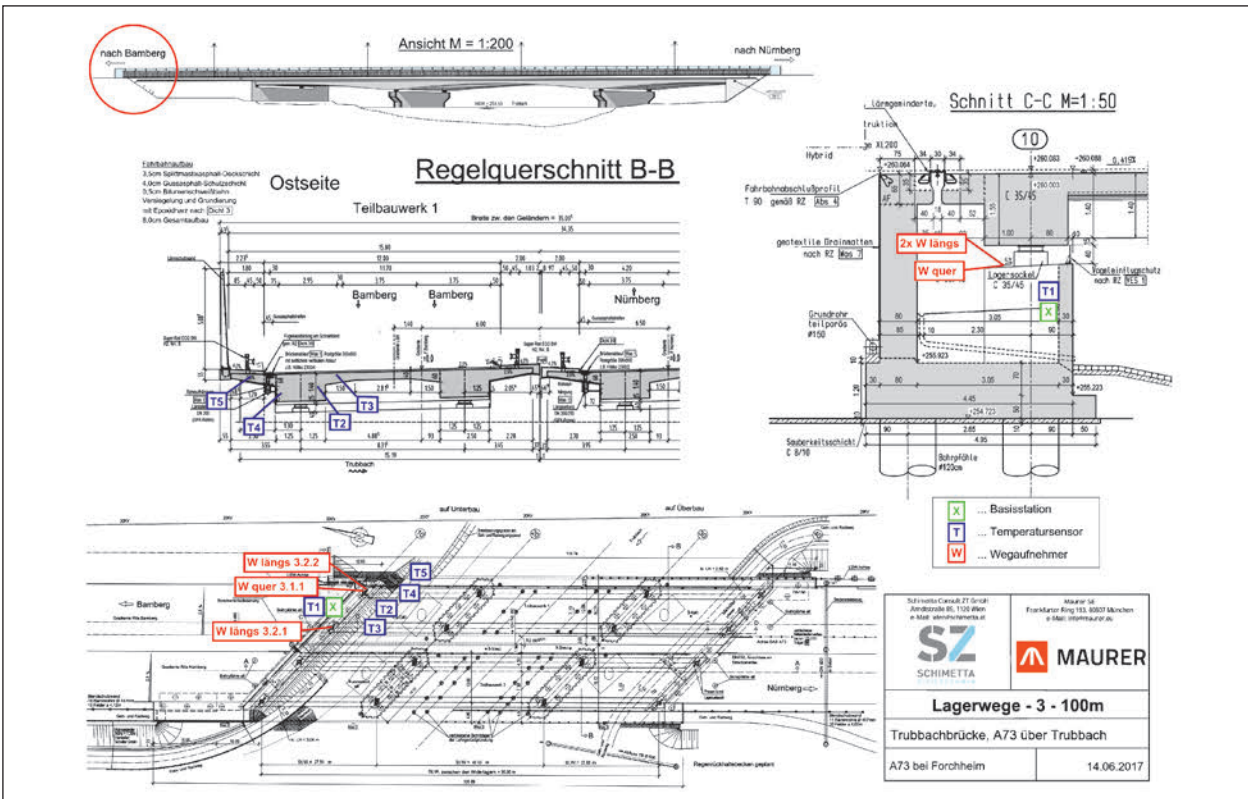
Sensorpositionen (3 – Trubbachbrücke)
